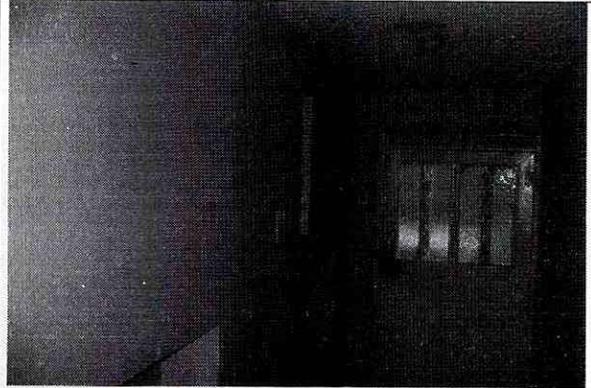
Muros internos del primer piso en buen estado, zona frontal
